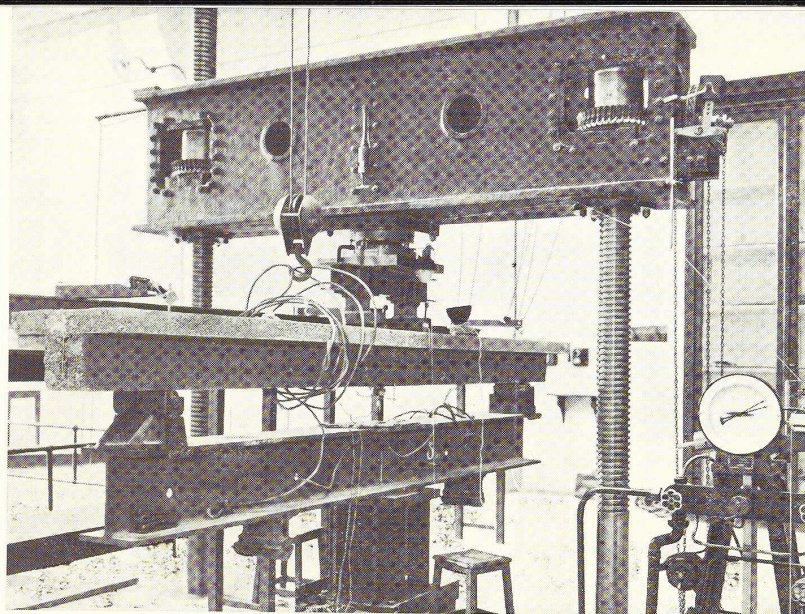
Montage des essais préliminaires sur poutre T à poutrelle enrobée, dans une machine d'essais de 300 tonnes de charge maximum, travaillant à la sensibilité de 30 tonnes.
